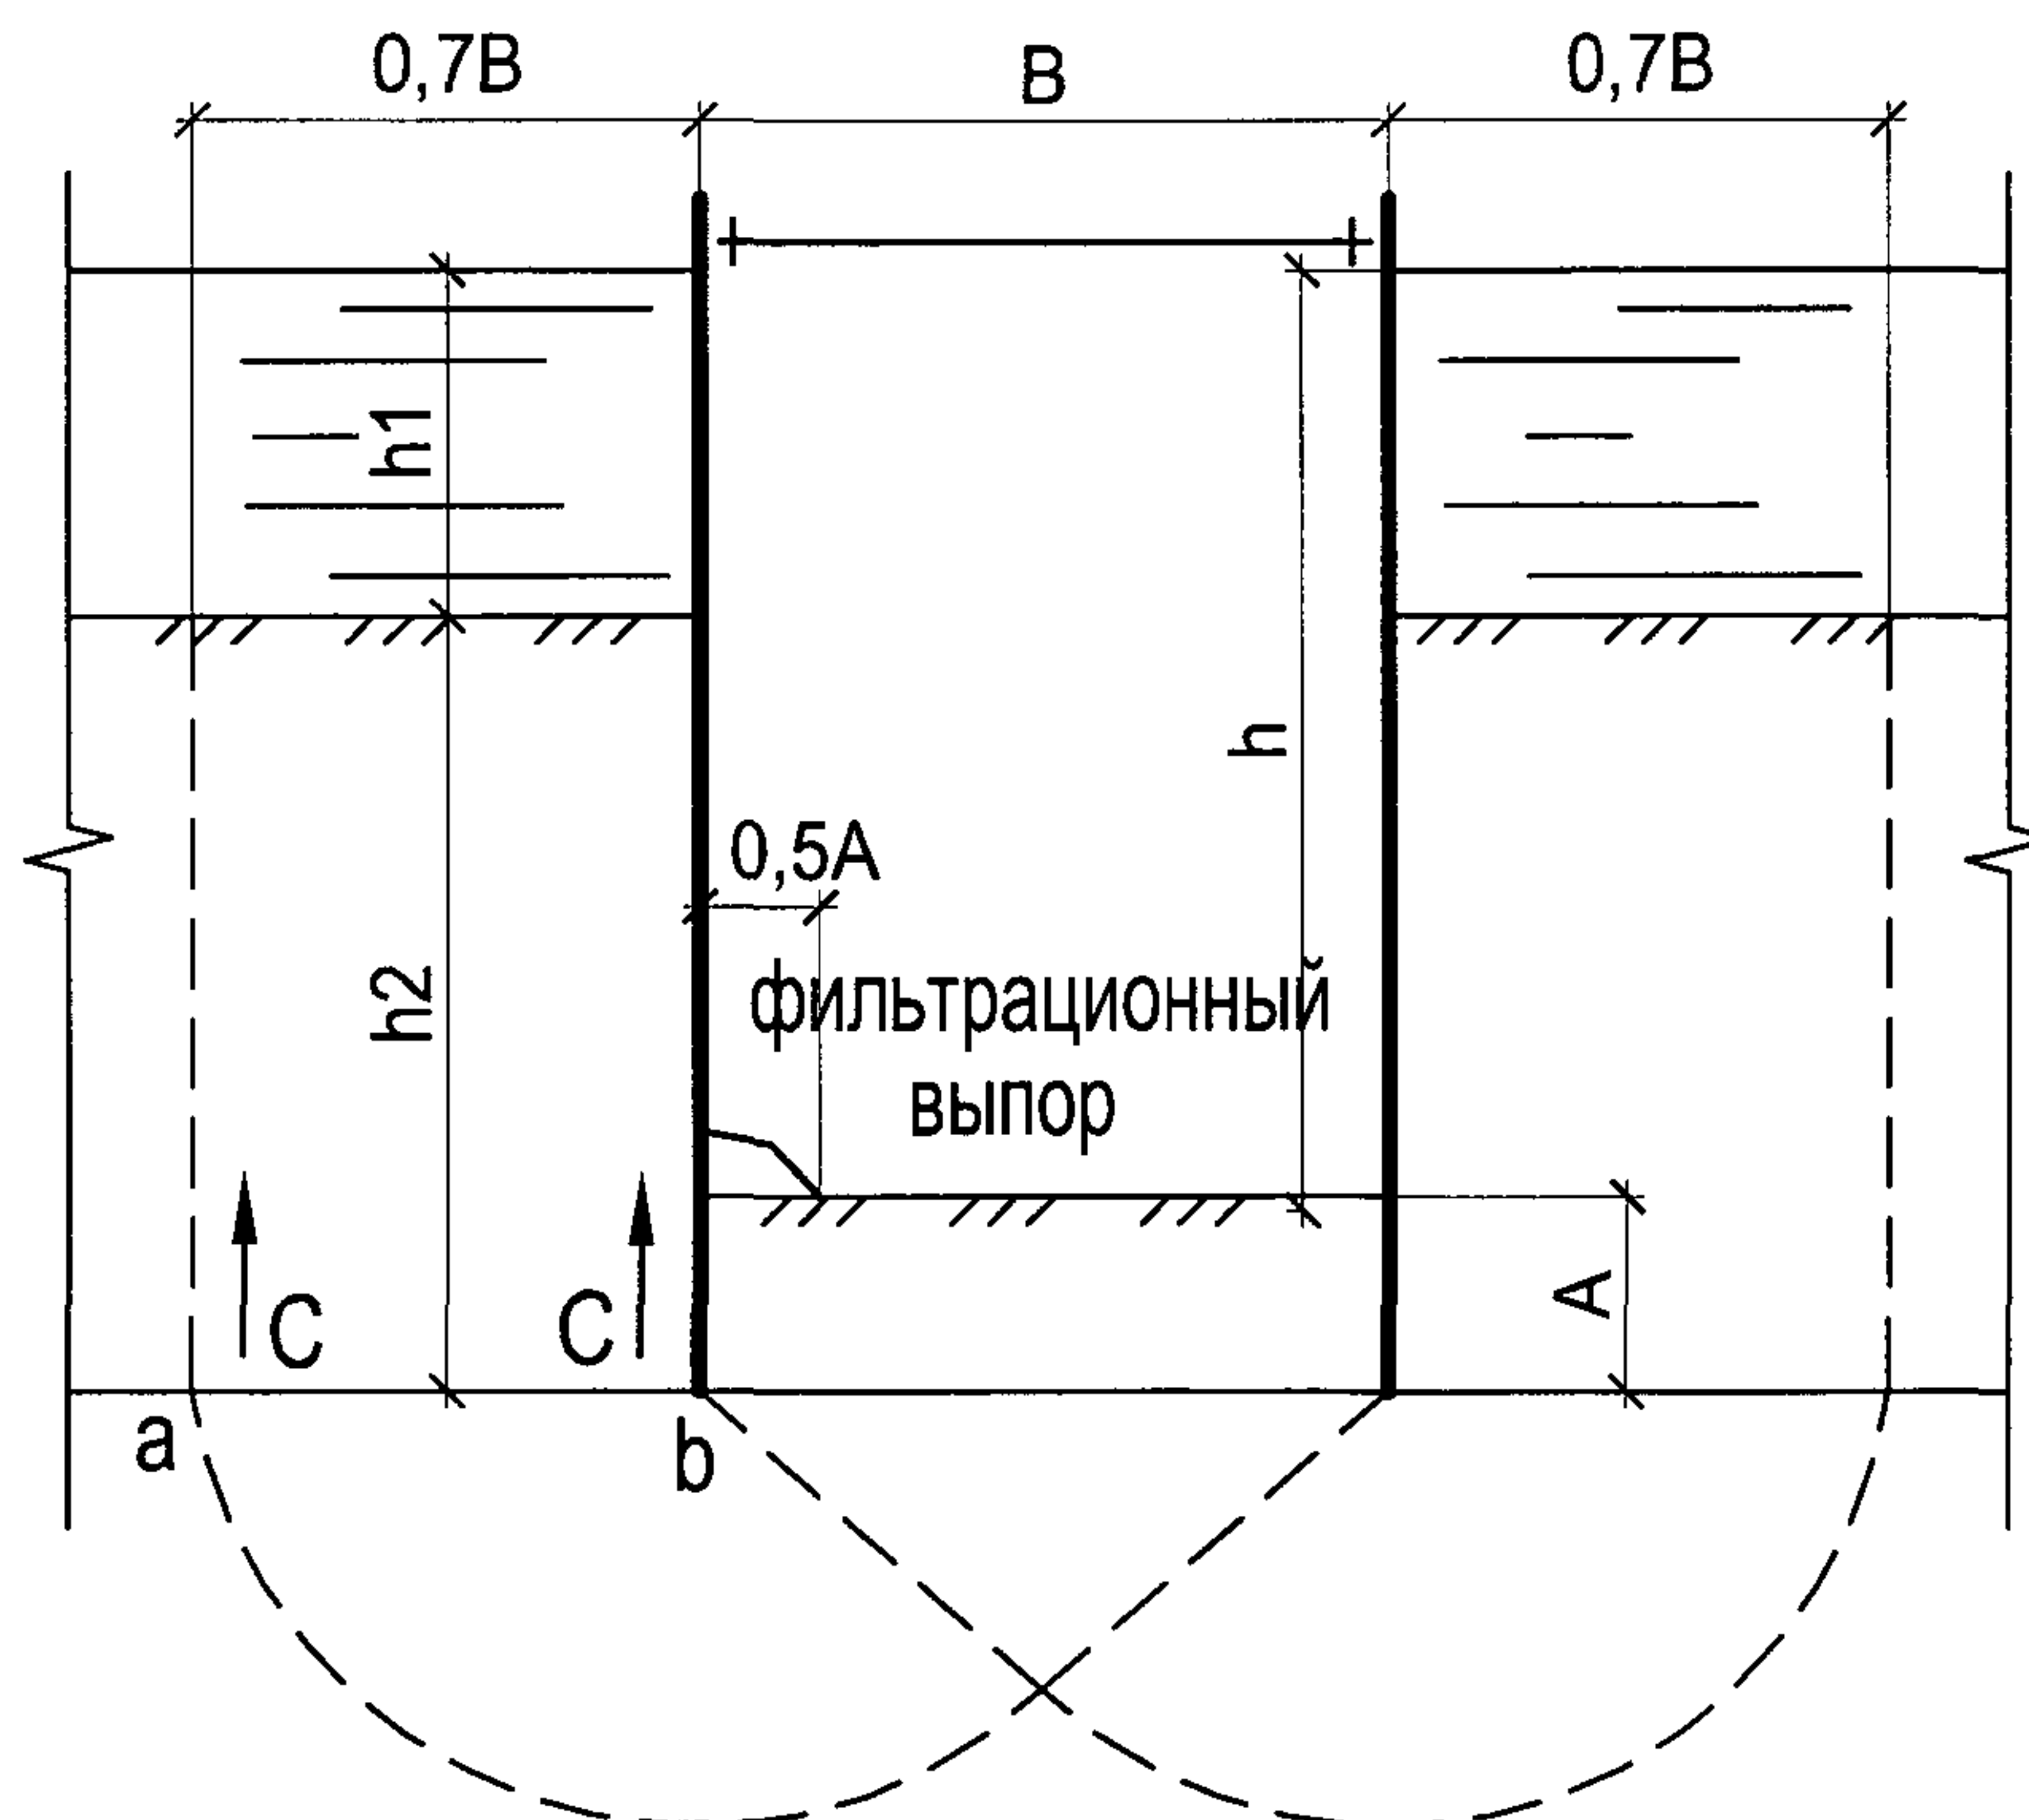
Расчетная схема к проверке дна котлована на выпучивание
